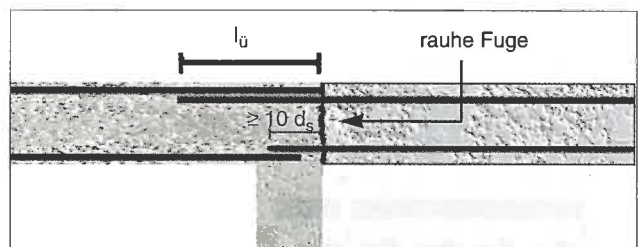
Anschluss einer Platte mit Anschlussbewehrung
